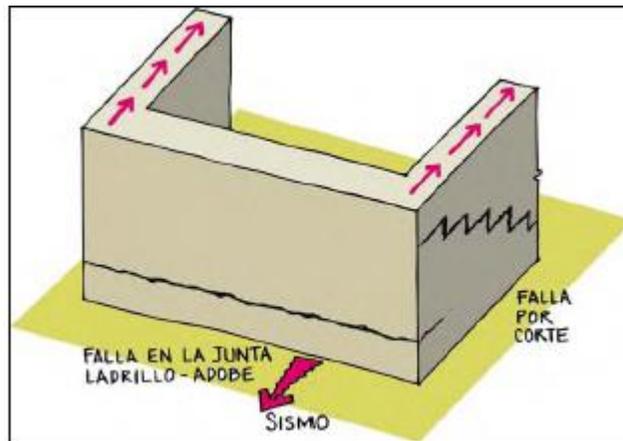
Ilustración de falla por cortante en el plano del muro asociado a altos empujes horizontales.
